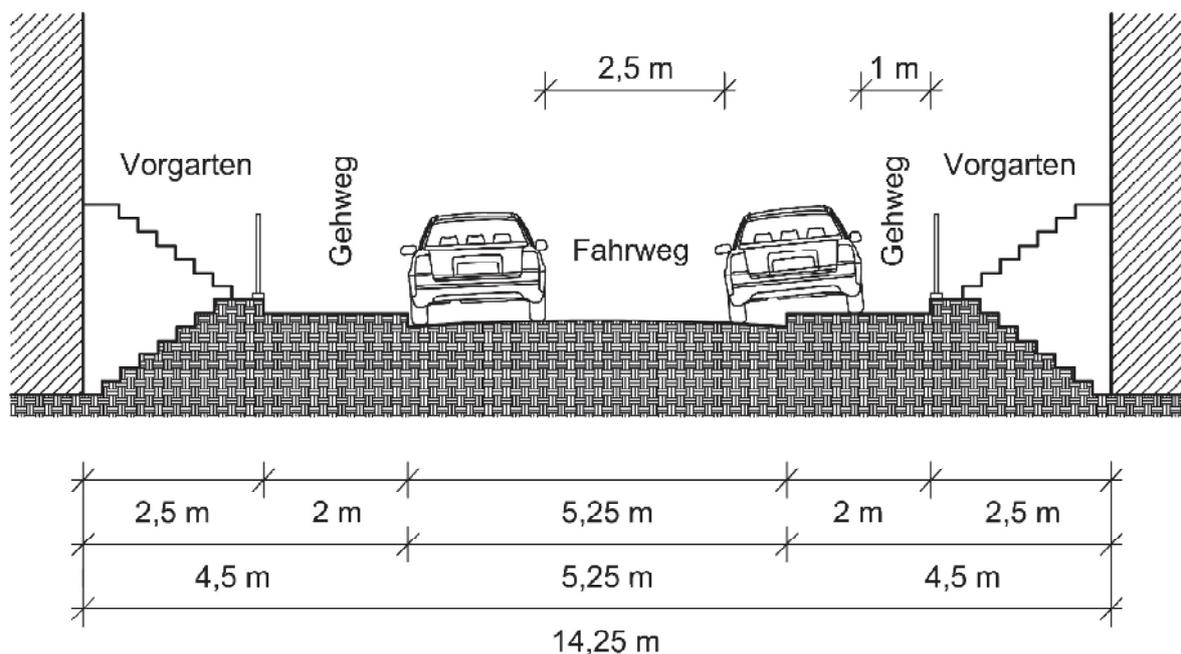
Straßenschnitt - Bückerburger Straße in Bremen (Eigene Darstellung, Maße: Bäuerle und Theiling 1997:114)
